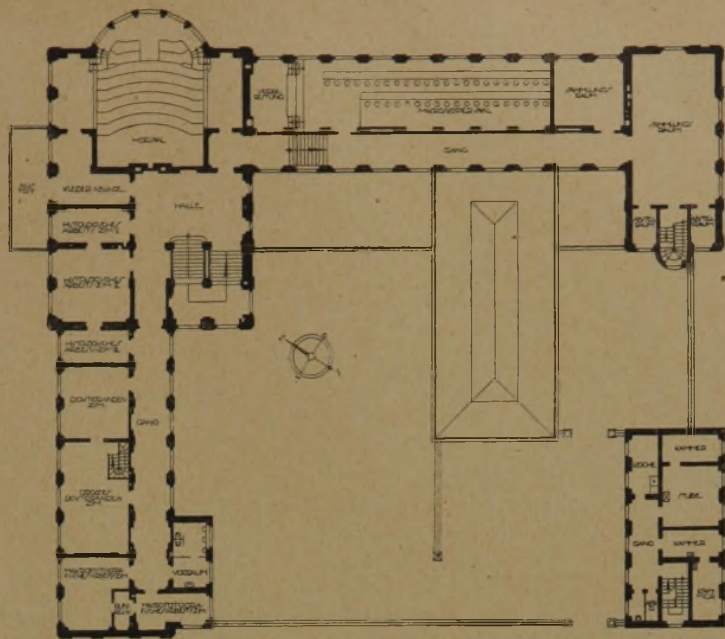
u. 5. Obergeschoß- und Erdgeschoß-Grundriß (1:500).
